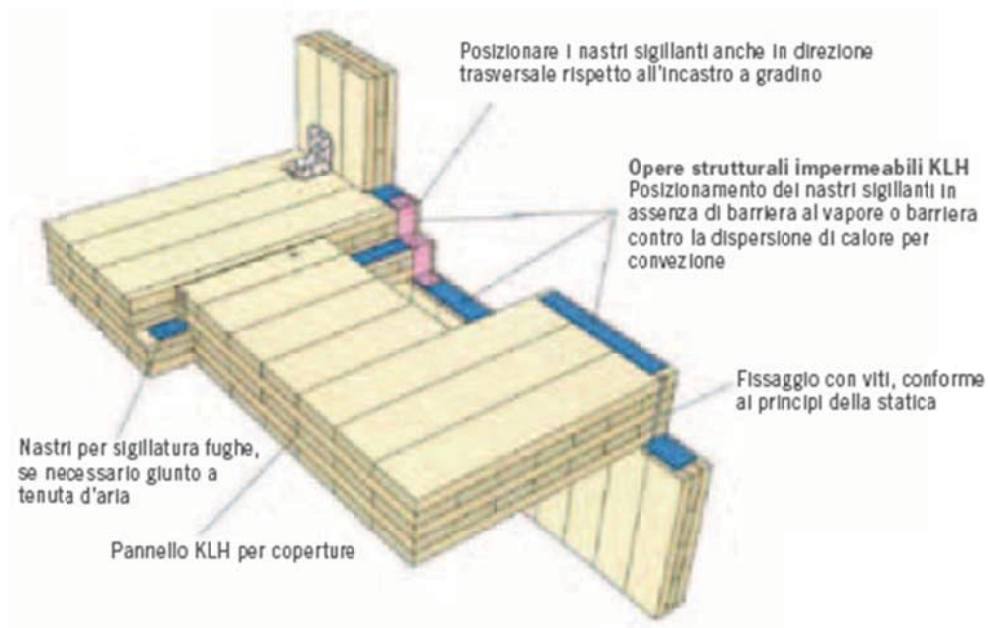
Sistema di collegamento parete – solaio con applicazioni di nastri sigillanti.⁽¹³⁾
